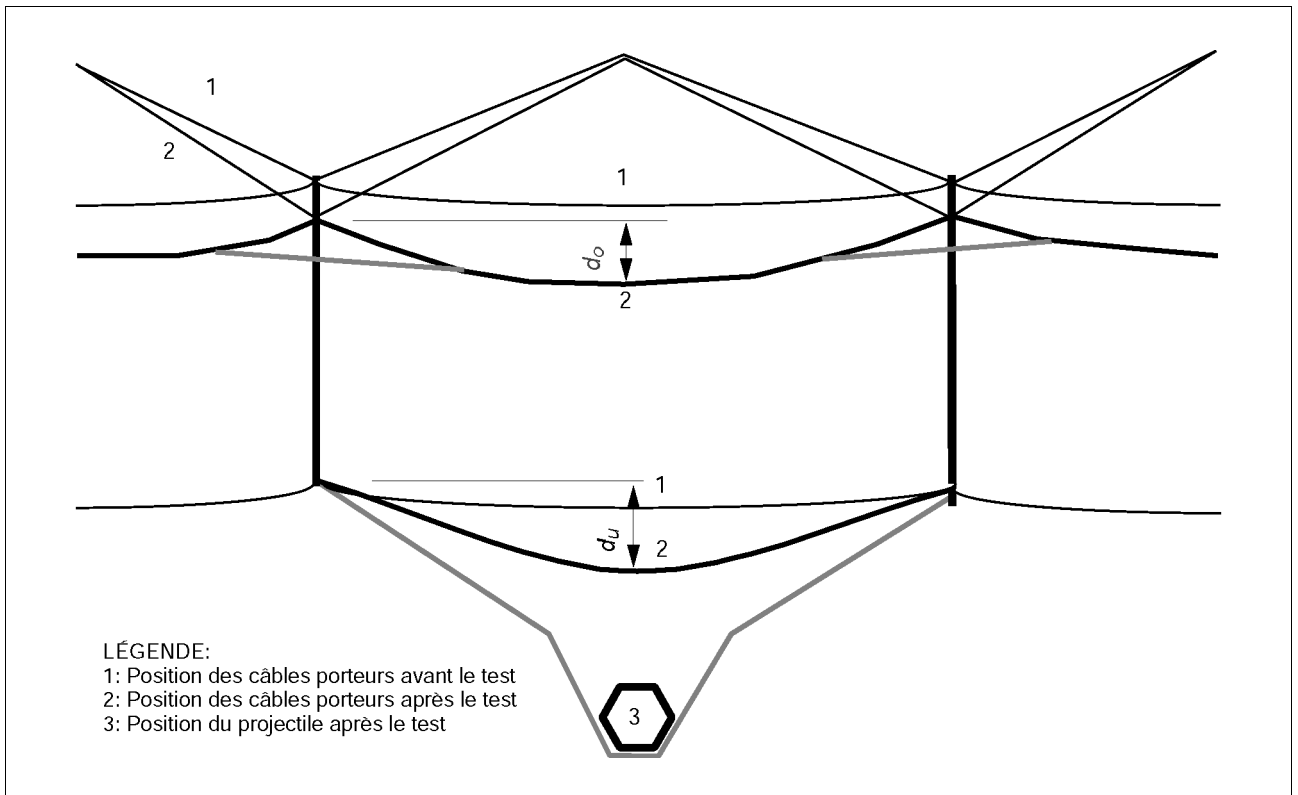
Vue de face des câbles porteurs au milieu de la section après la chute d'un projectile.
